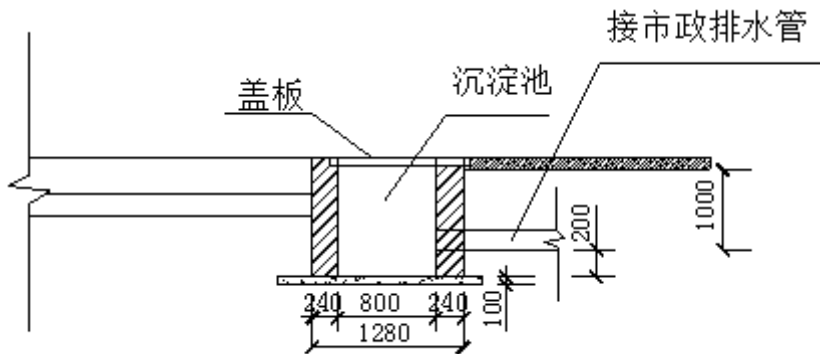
沉淀池剖面图（图中尺寸单位为 mm）
